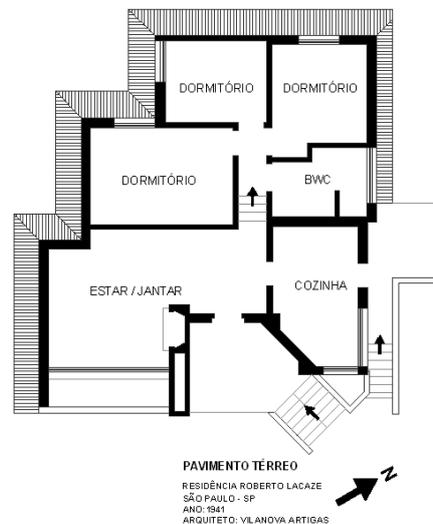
Redesenho da planta baixa da residência de Roberto Lacaze
